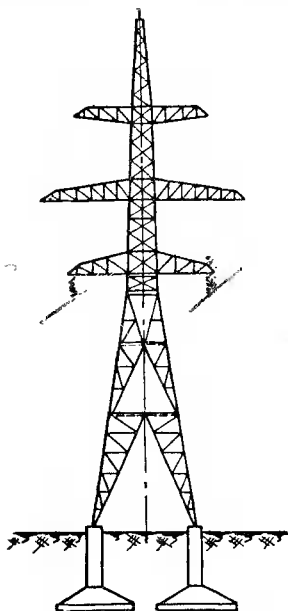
Анкерно-угловая двухцепная металлическая опора на сборном железобетонном фундаменте.
